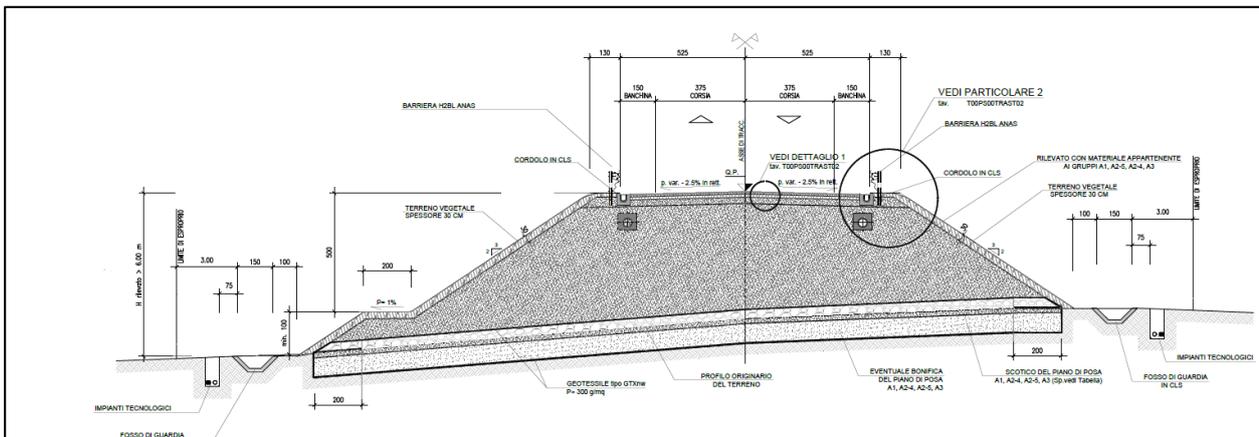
Sezione tipo C1 in rilevato con H>5 e H<6
